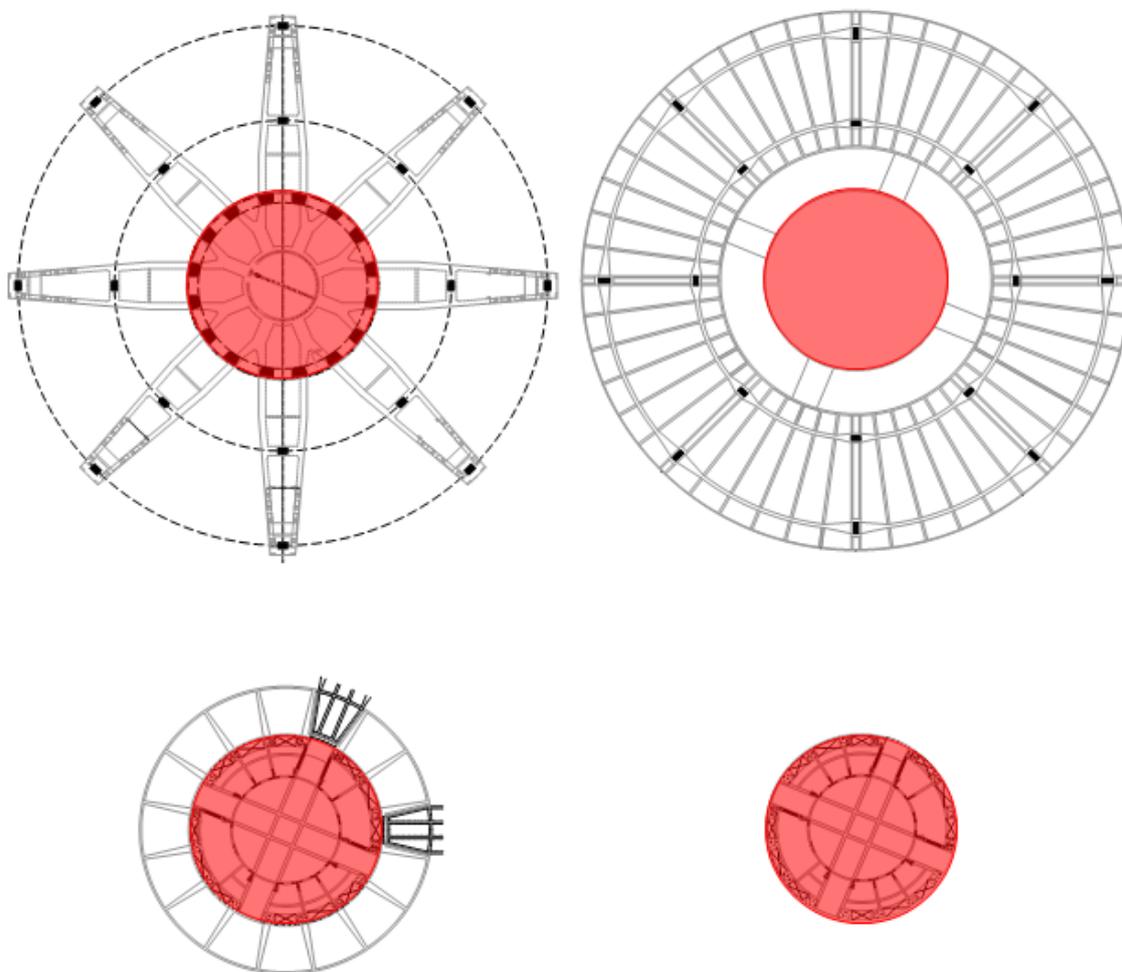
Planta estrutural das vigas de cobertura, Pavimento tipo, Mezanino e núcleo rígido, bloco A, PGR. Fonte: Arquivo da PGR, desenho do autor.
